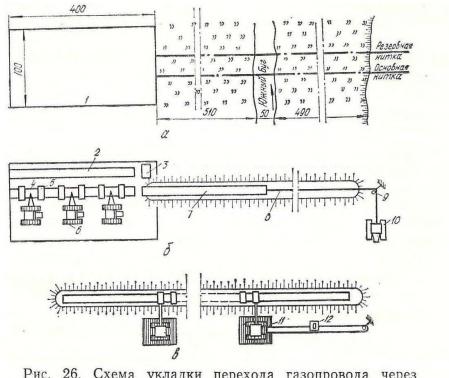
Схема укладки перехода газопровода через р. Южный Буг:
